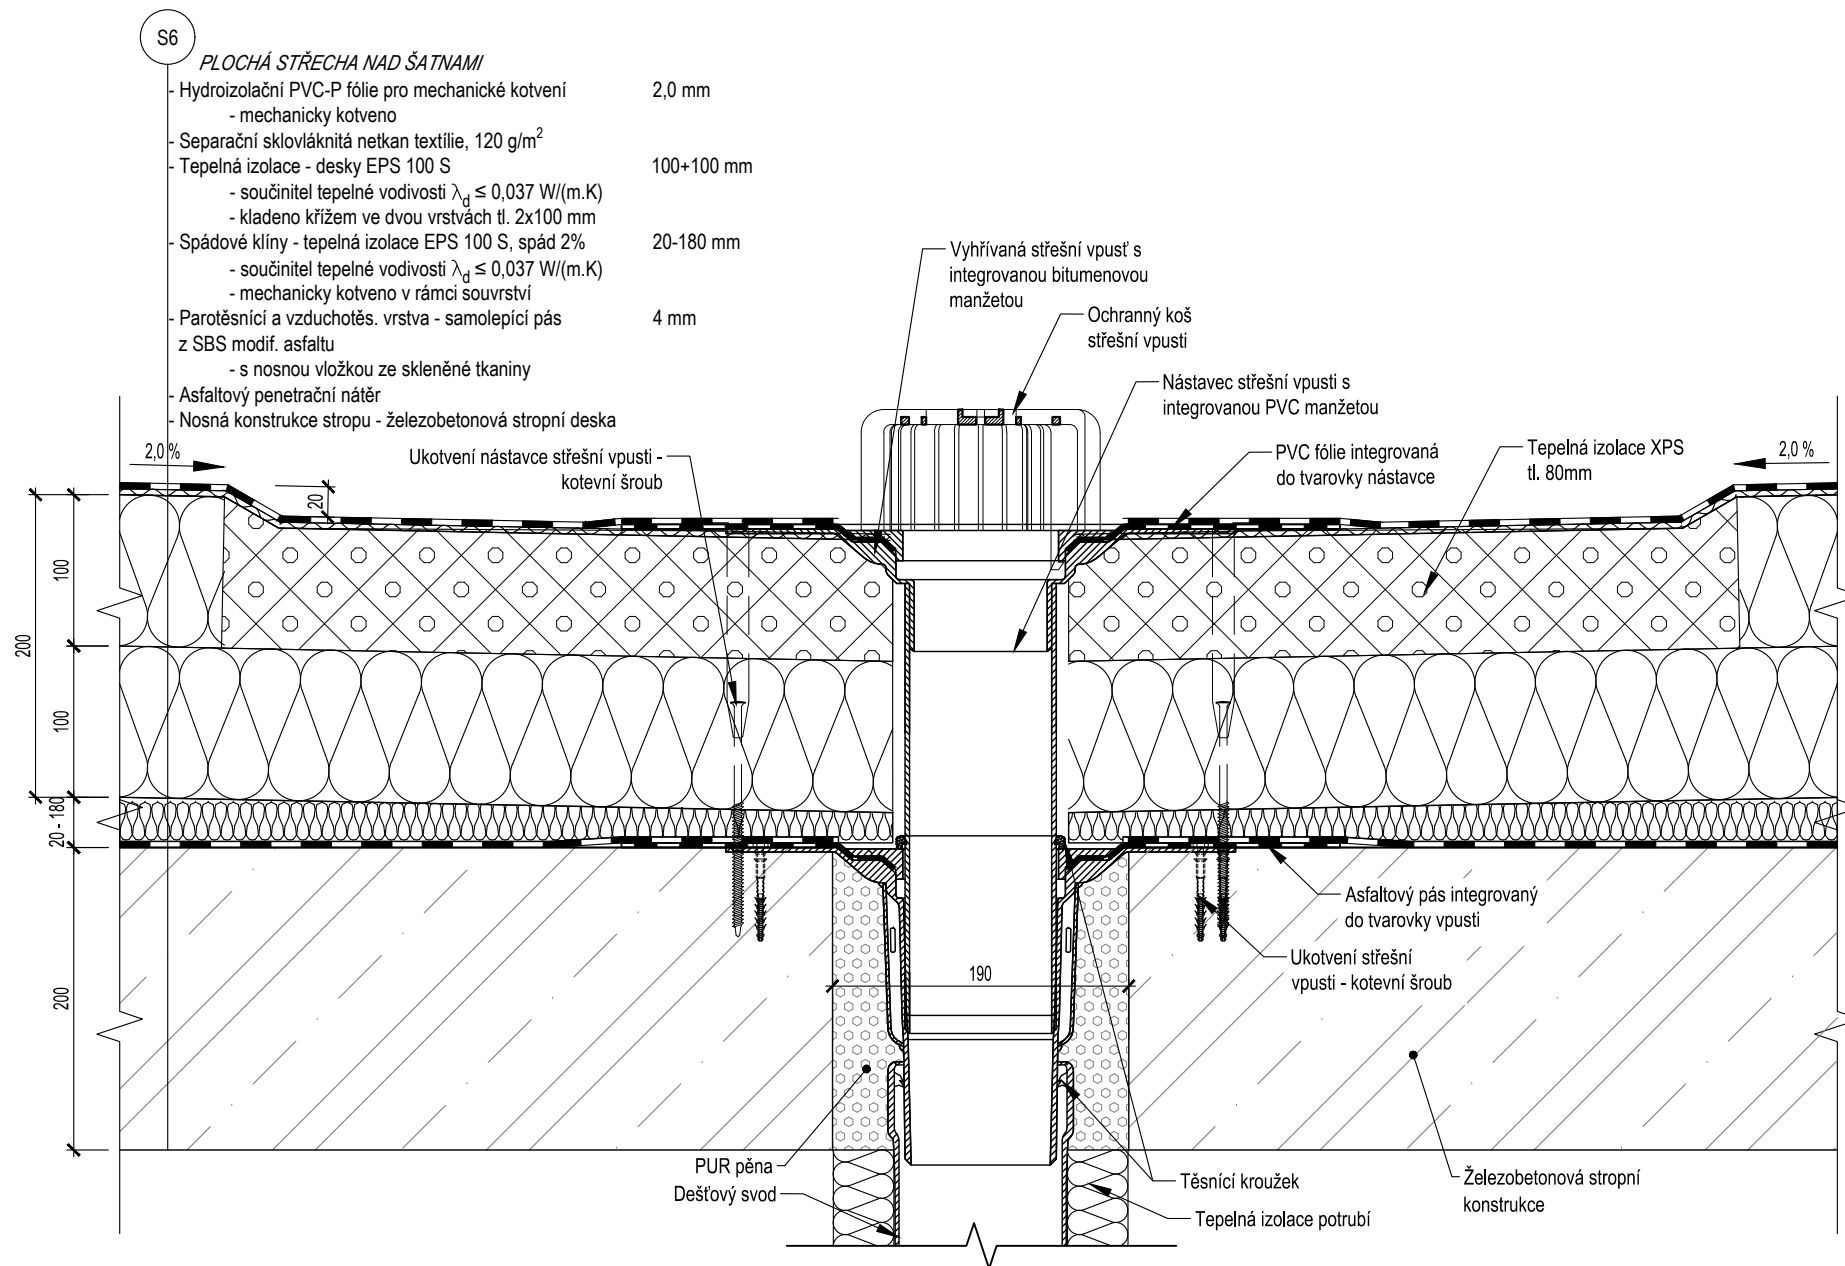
" - STŘEŠNÍ VPUŠŤ - STŘECHA S5
